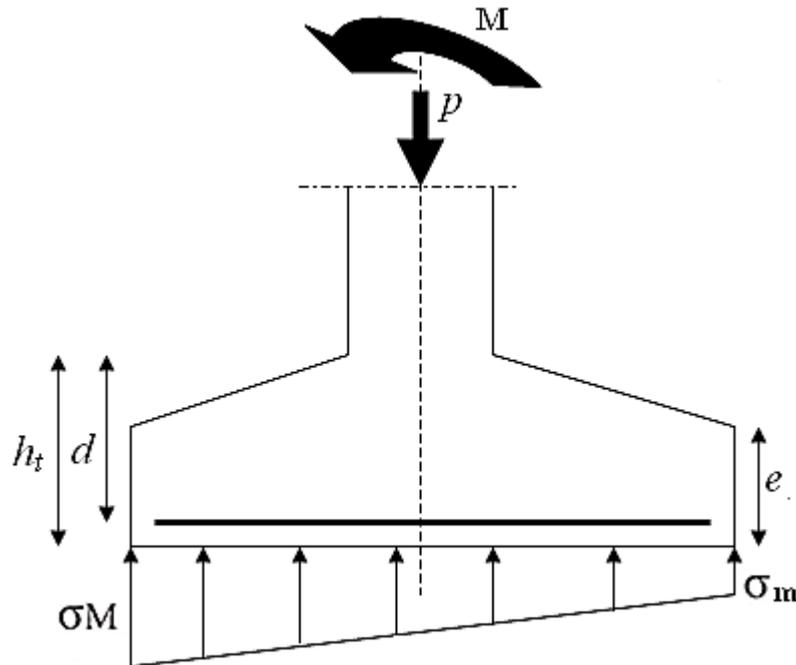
Diagramme des contraintes agissant sur les fondations
